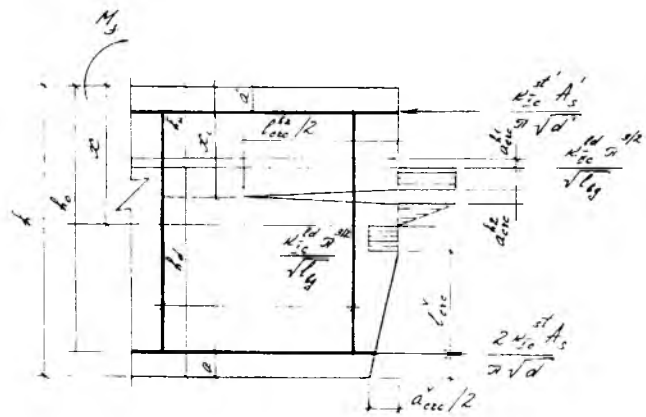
Нормальное сечение двухслойного изгибаемого железобетонного элемента на стадии IV₁-1
